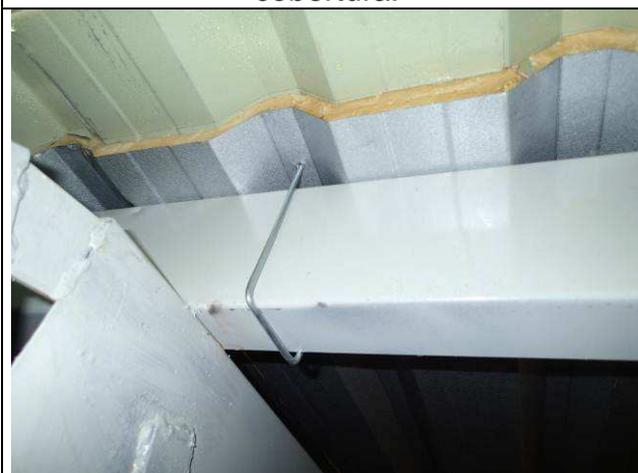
C: Estrutura metálica de cobertura – fixação das telhas
